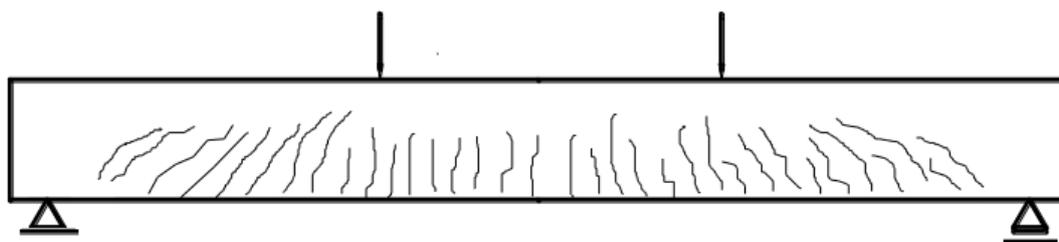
Padrão de fissuração da viga (LEONHARDT & MÖNNING, 1982)
